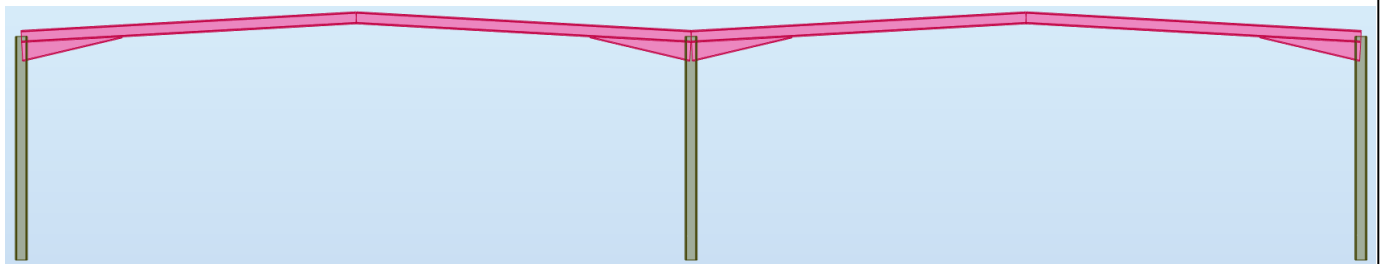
Поперечний переріз з ПК Robot Structural Analysis
